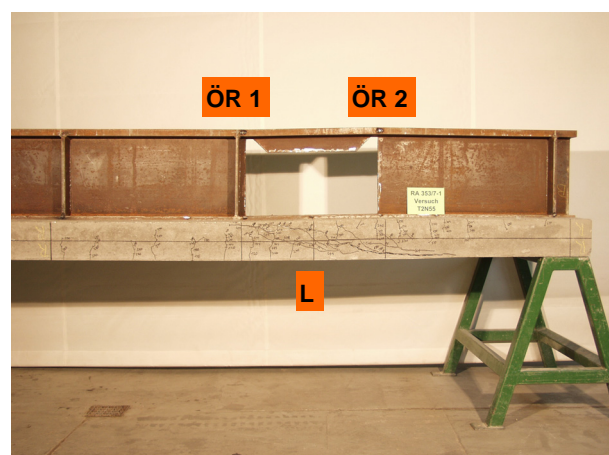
Rissbild auf der linken Betongurtseite
